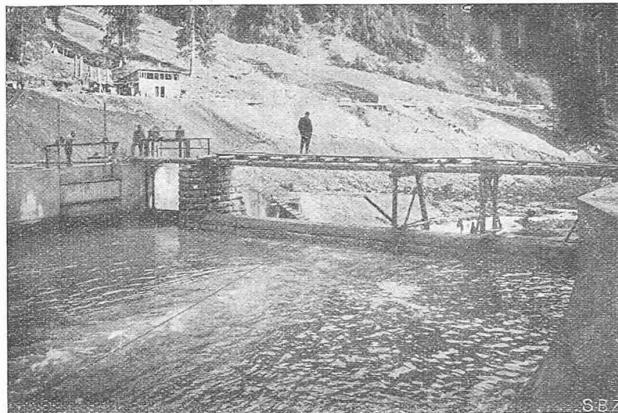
Wehr mit Grundablass und Einlauf (21. Sept. 1921).
